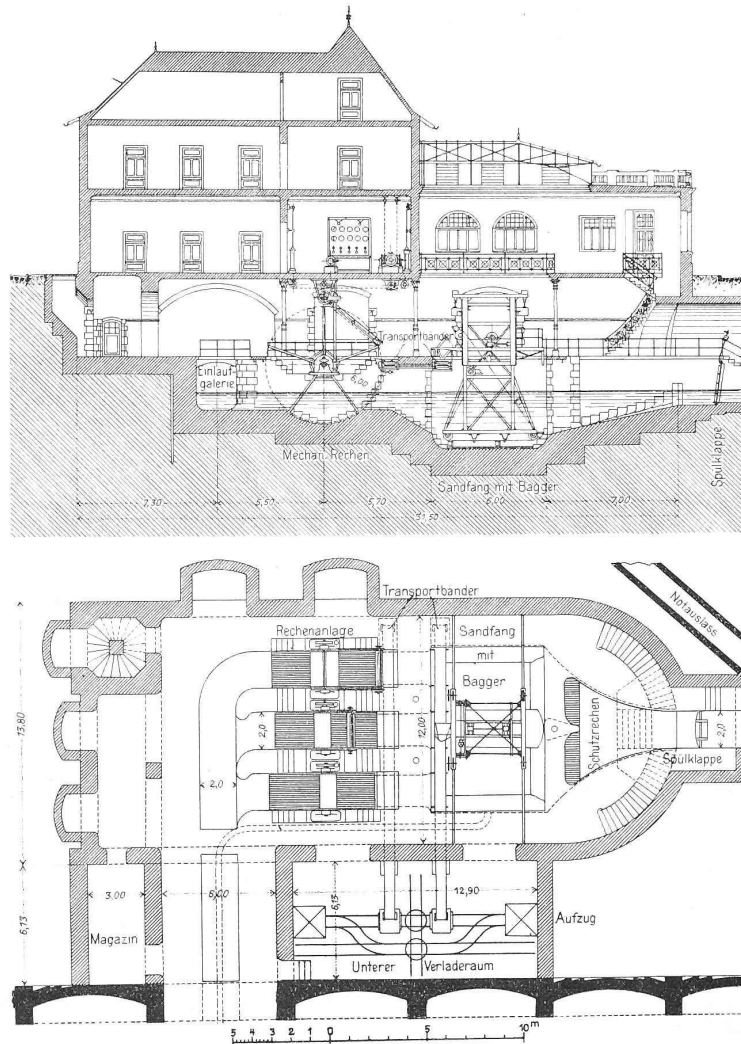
Grundriss und Längsschnitt der Rechen- und Baggeranlage der Klärbecken. — Masstab 1 : 350.
